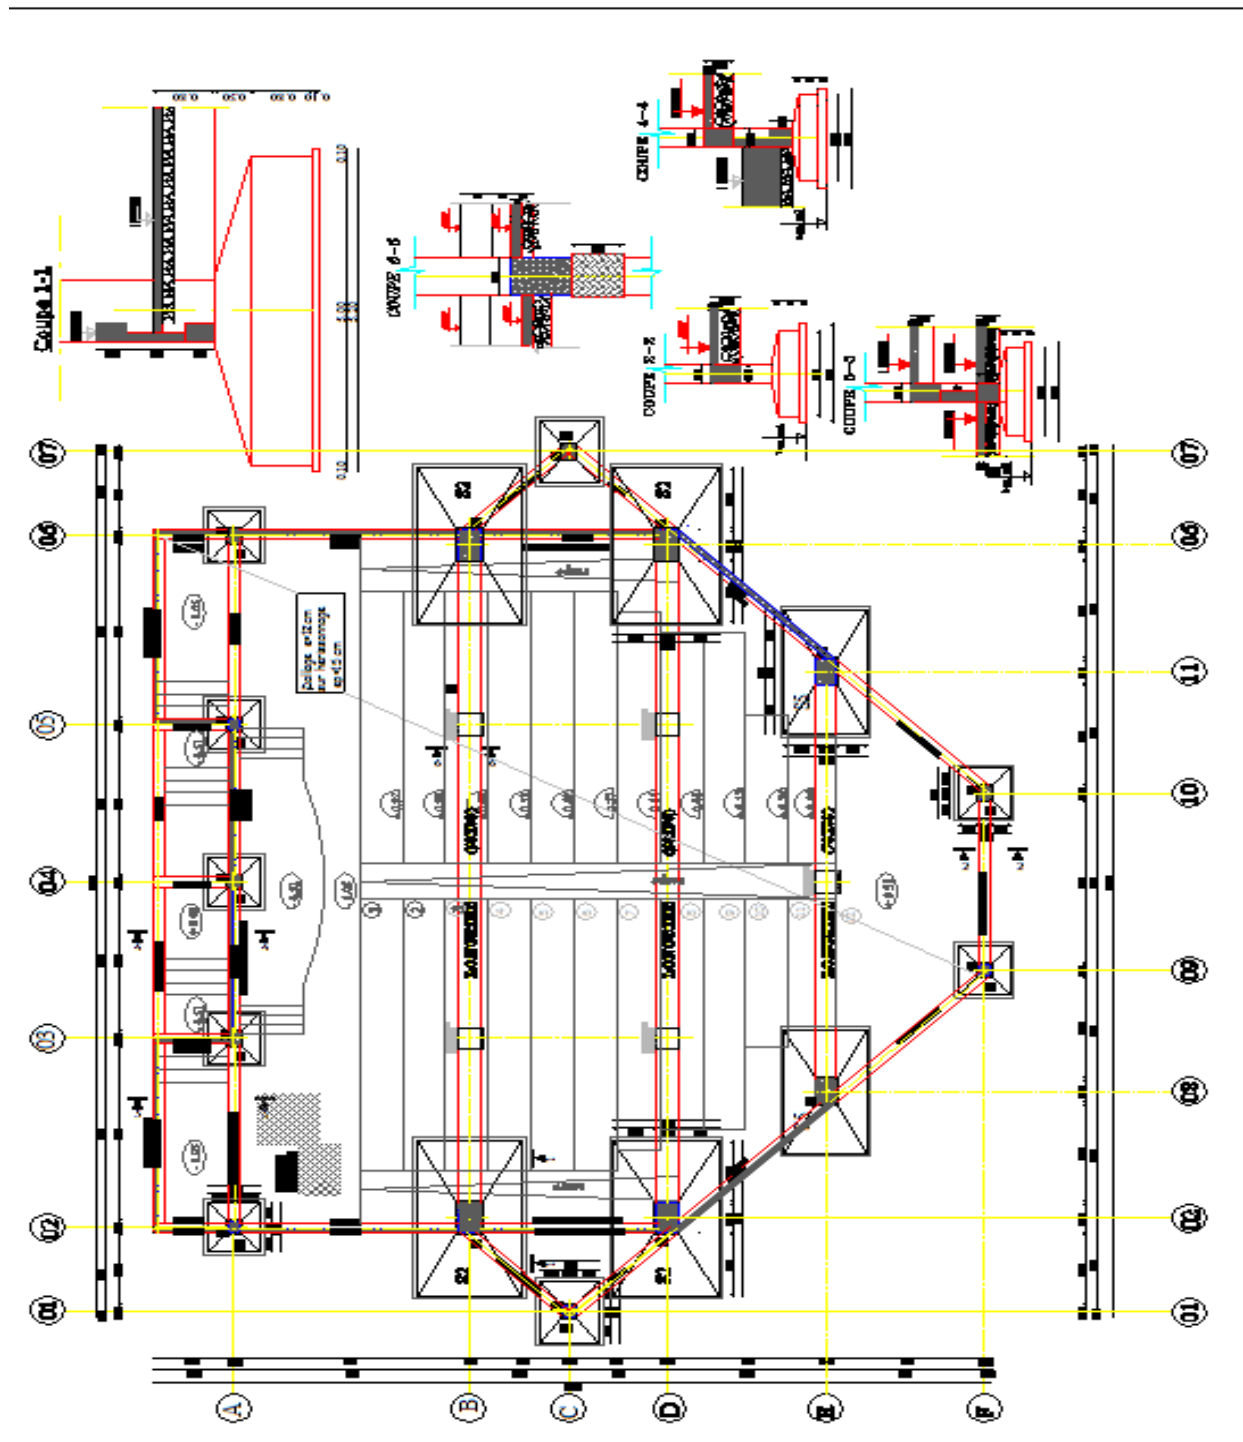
Coffrage des fondations échelle 1/200 [2].
